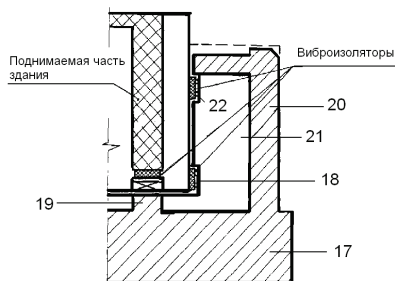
Схема виброизоляции цокольного этажа в основании здания.
